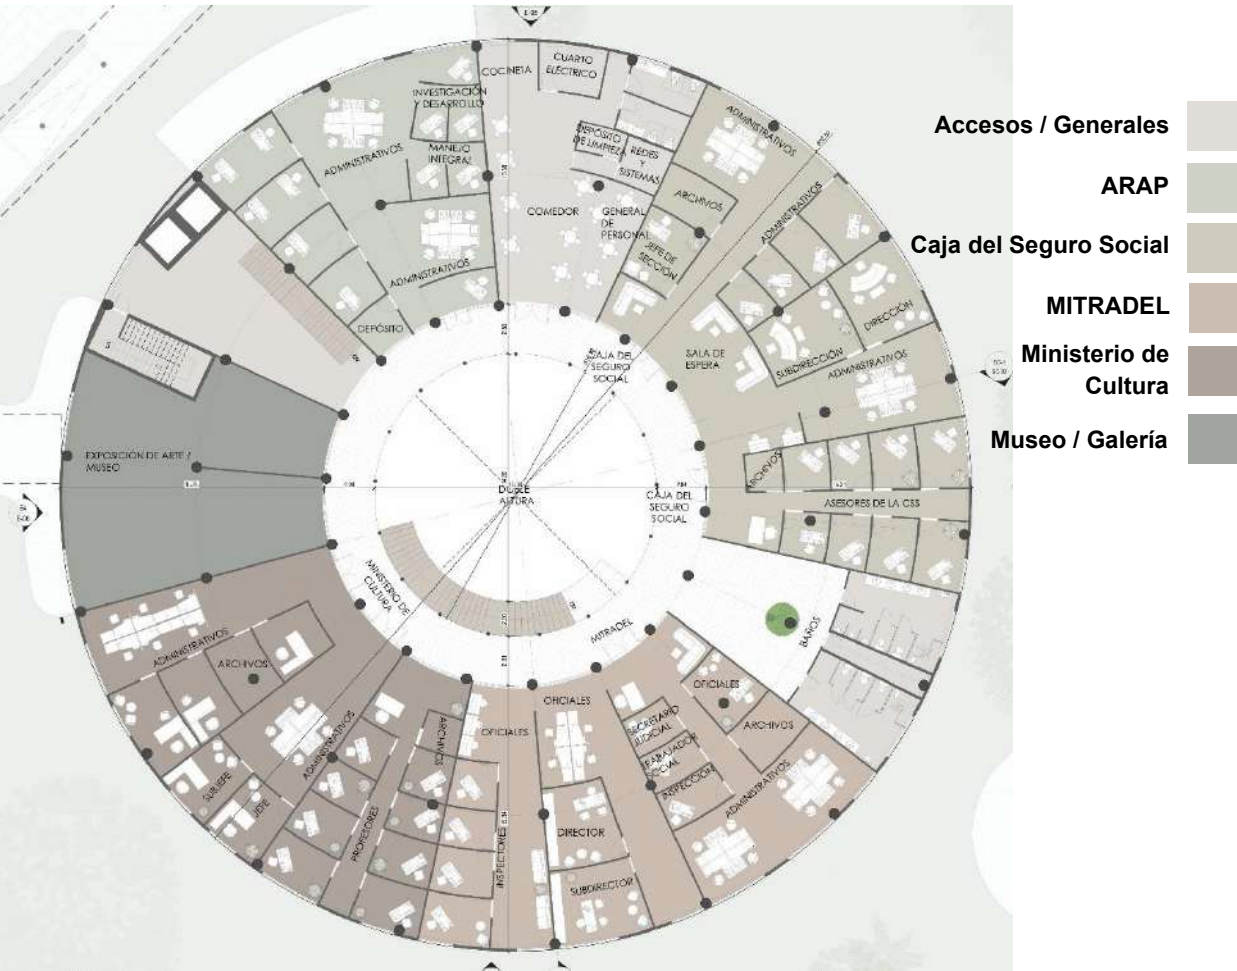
Ampliación de la planta alta de la torre B. Fuente: elaboración propia 2025
